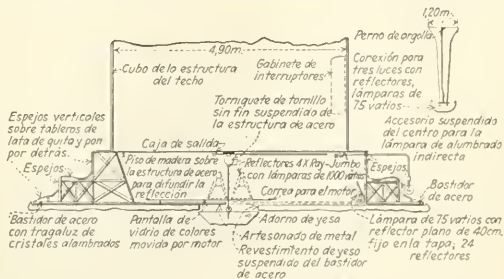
DETALLES DEL APARATO CENTRAL INSTALADO EN LA BÓVEDA
